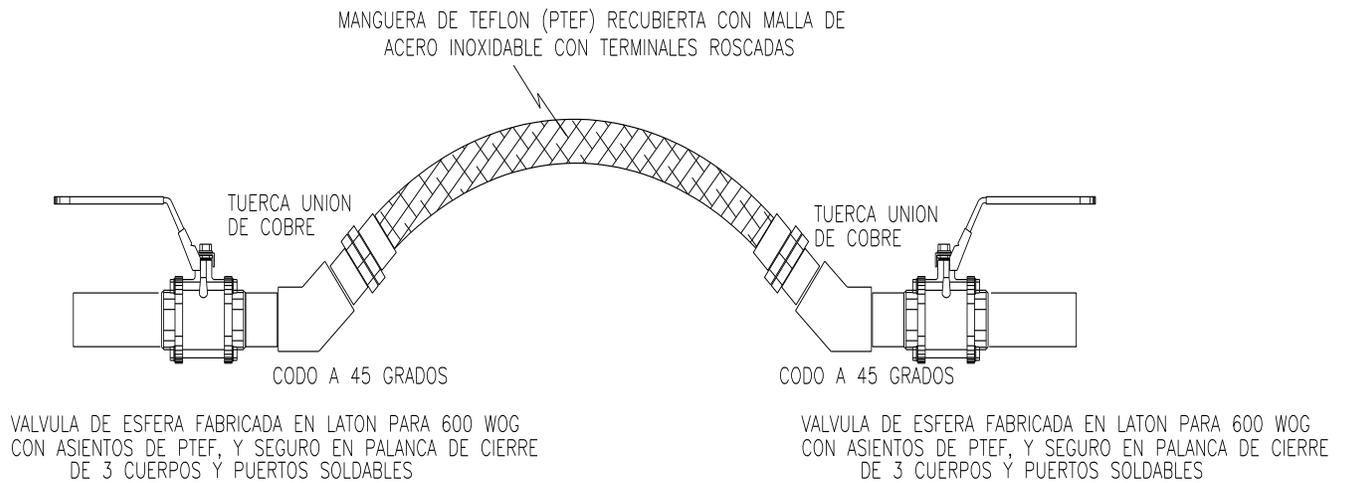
A.- Manguera Flexible en Junta Constructiva.
